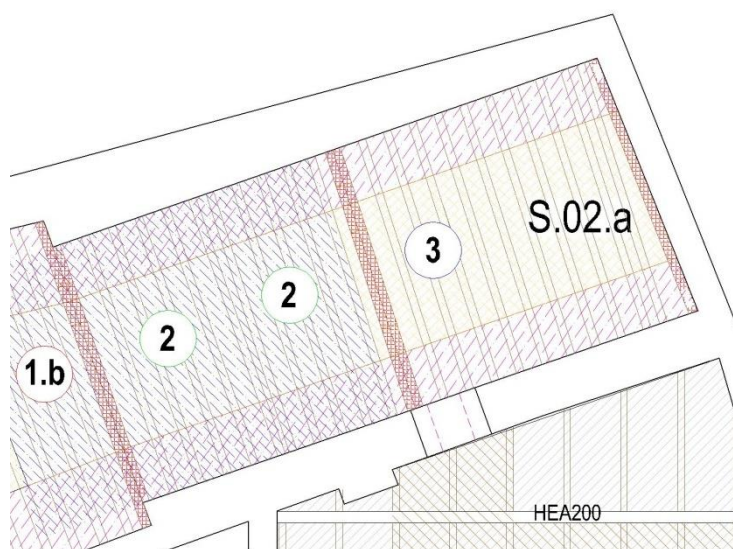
Pianta strutture controsoffitto vano S.02a
